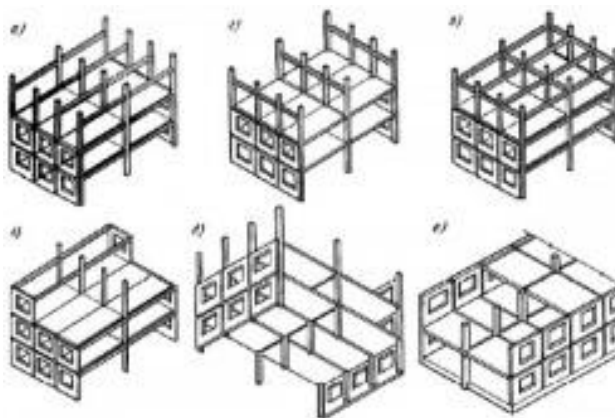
Конструктивные схемы каркасно-панельных зданий
